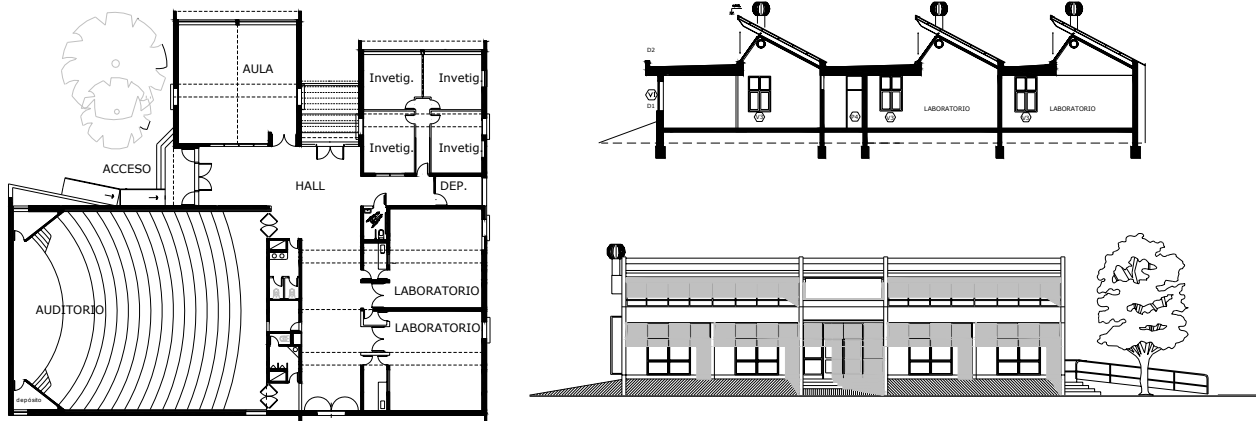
Planta y corte del Pabellón de Ciencias Exactas
